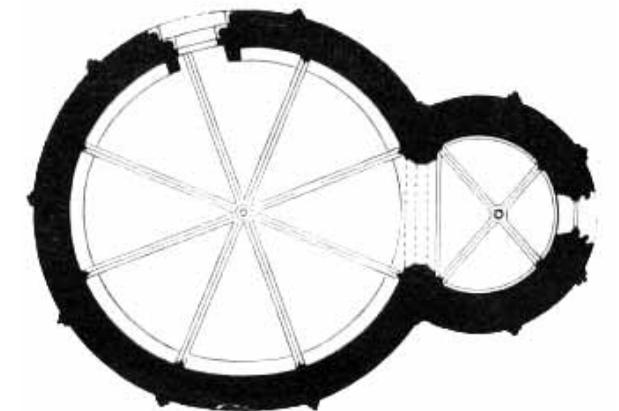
Grundriss Pulkau (DM 10,80 m), M 1:200. MdkkCC 1886, 160.
